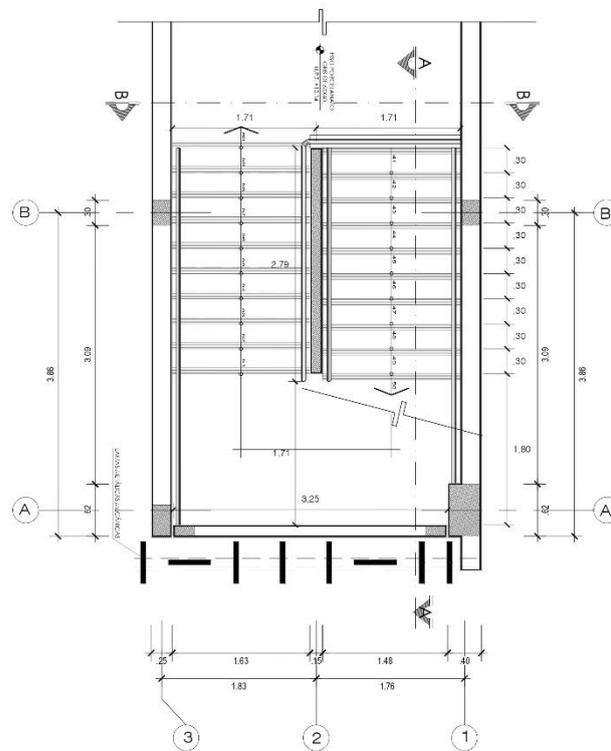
Lámina A-40: Plano de Distribución – Escalera U -02
